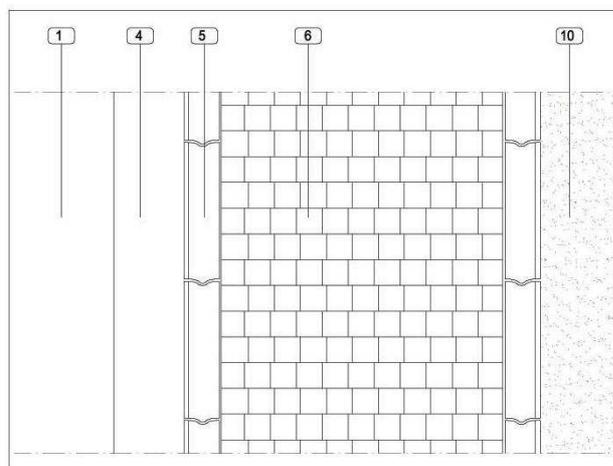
pianta marciapiede con pavimentazione a tozzetti di cls
